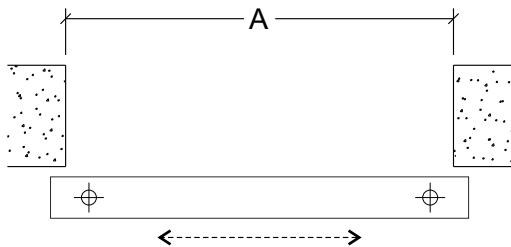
Detalle en planta de puerta industrial corredera apoyada
